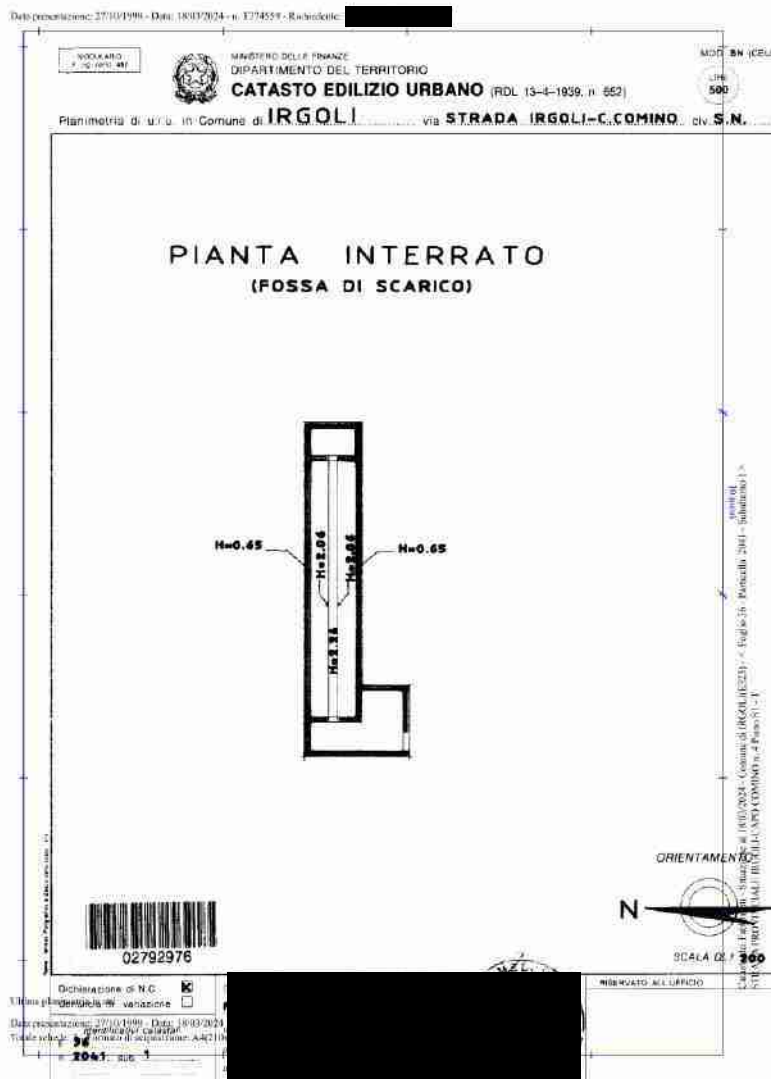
\_planimetria catastale del f.36 p.Ila 2041 sub.1/parte (fossa di scarico)
